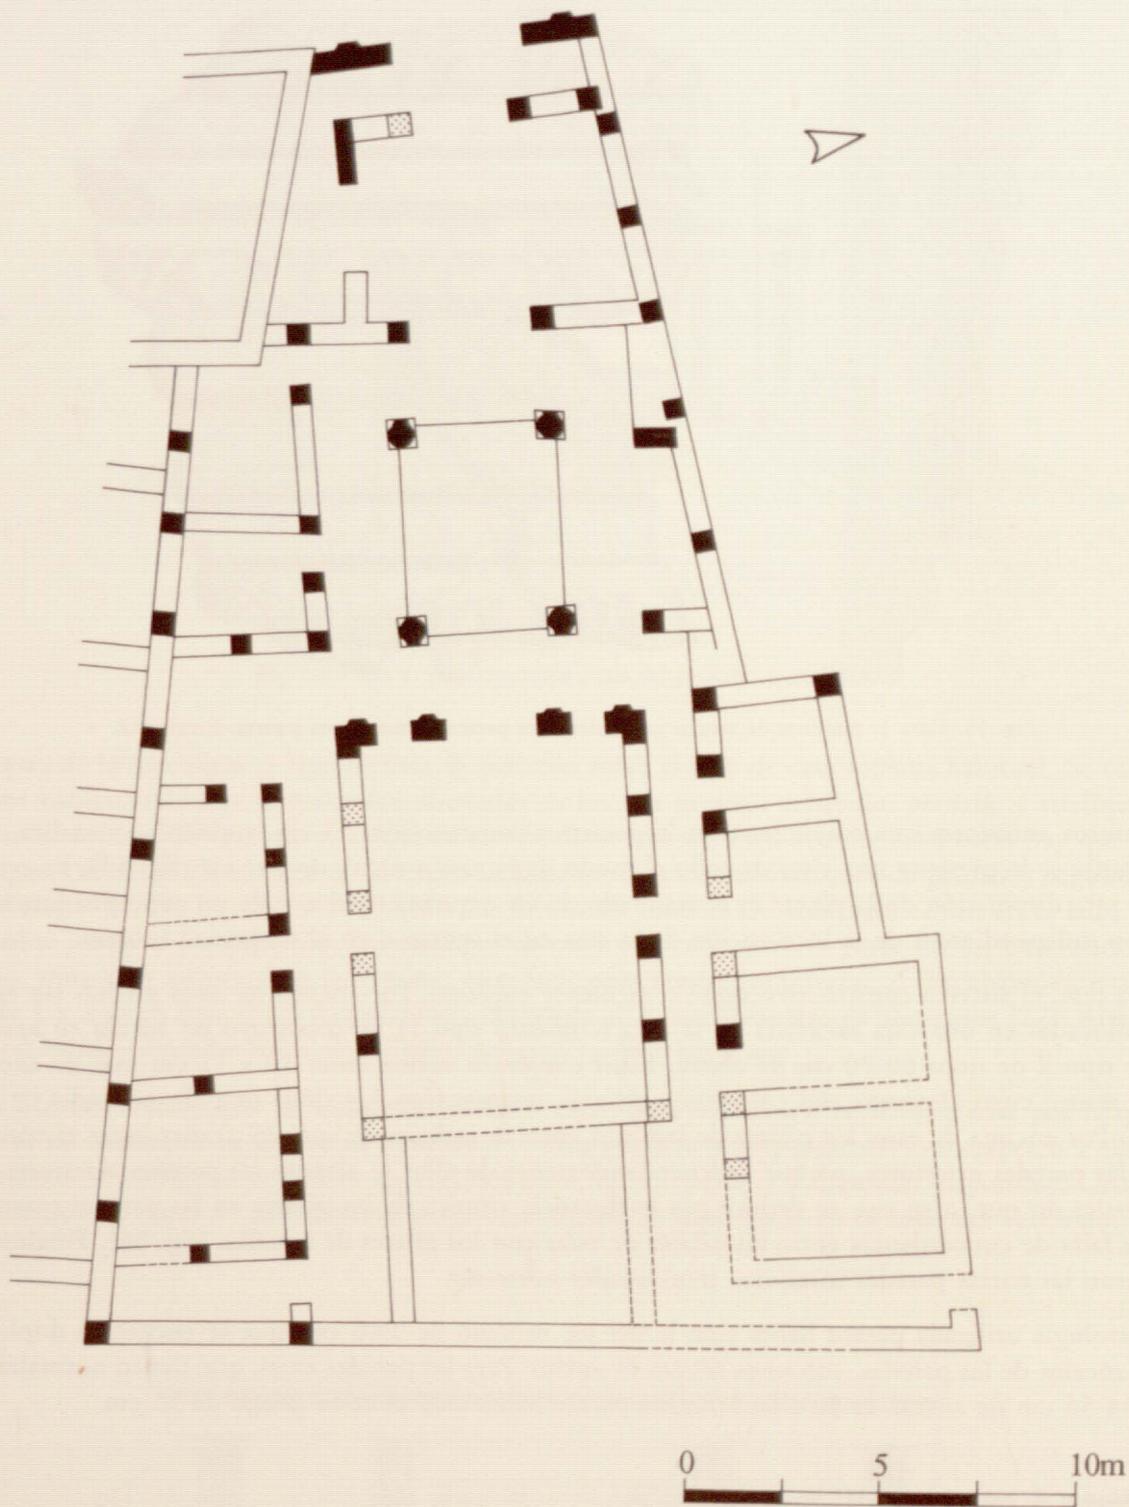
Casa I, zócalos de pared en técnica *opus mixtum* 1 reconstruidos (en gris), y situación de los pilares de ladrillos conservados (en negro).
